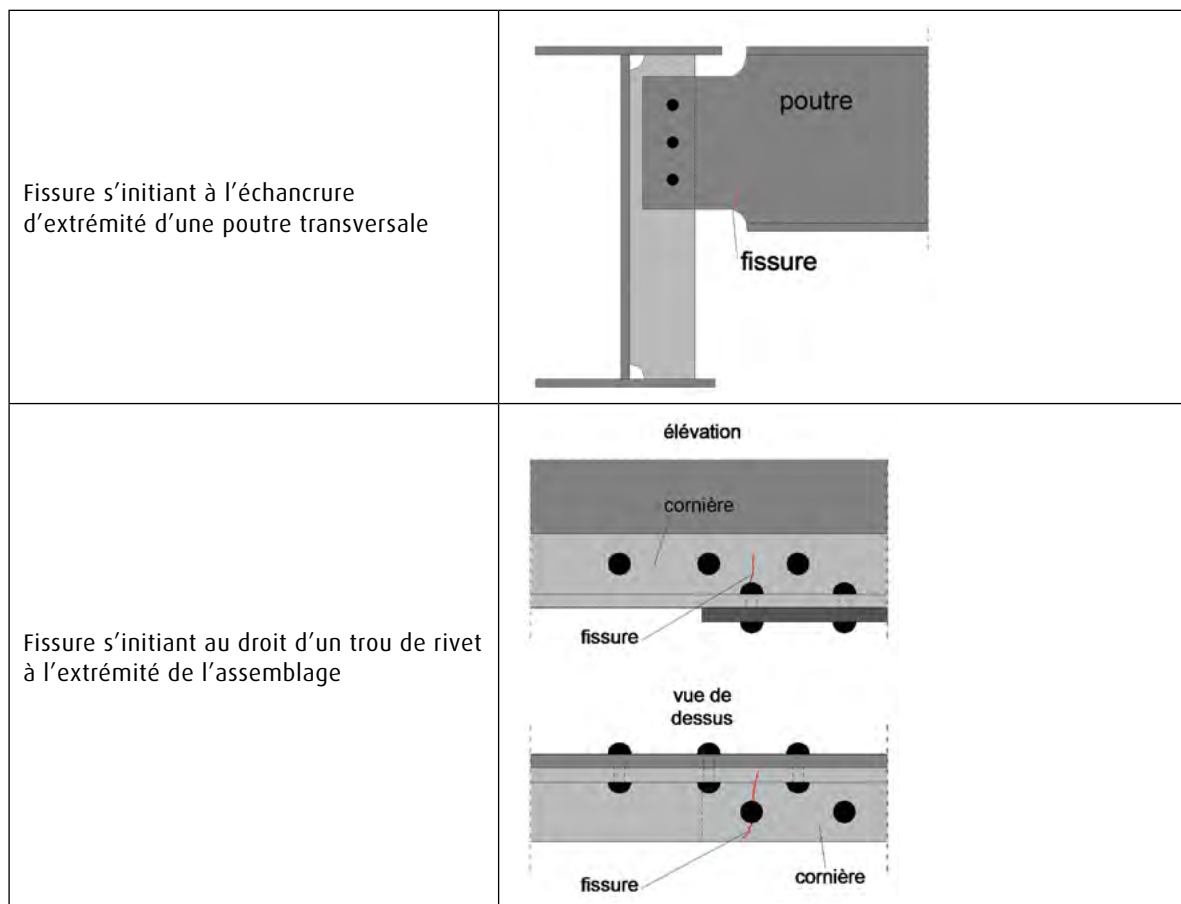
Exemples de mauvaises dispositions ayant conduit à l'apparition de fissures
